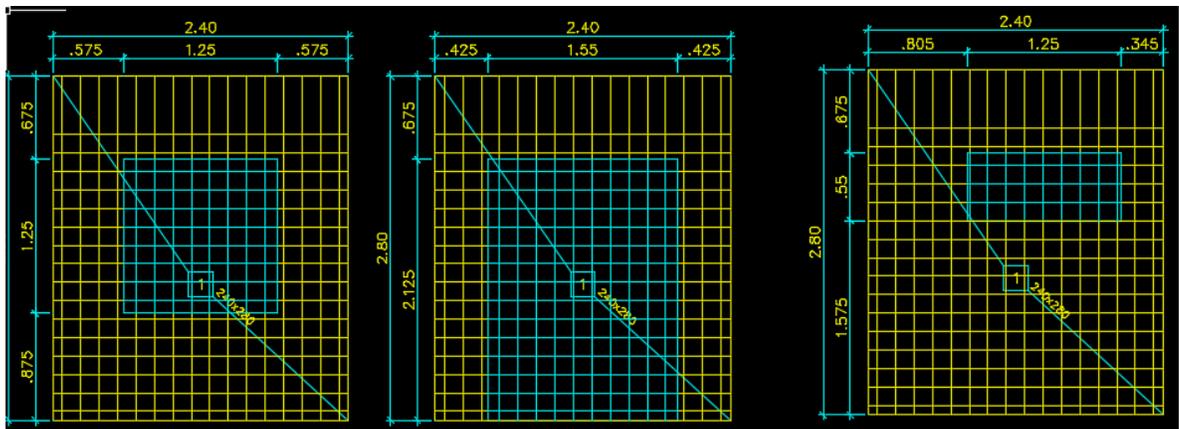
Detalles de corte para ventanas (Fuente: Occviles S.A)
